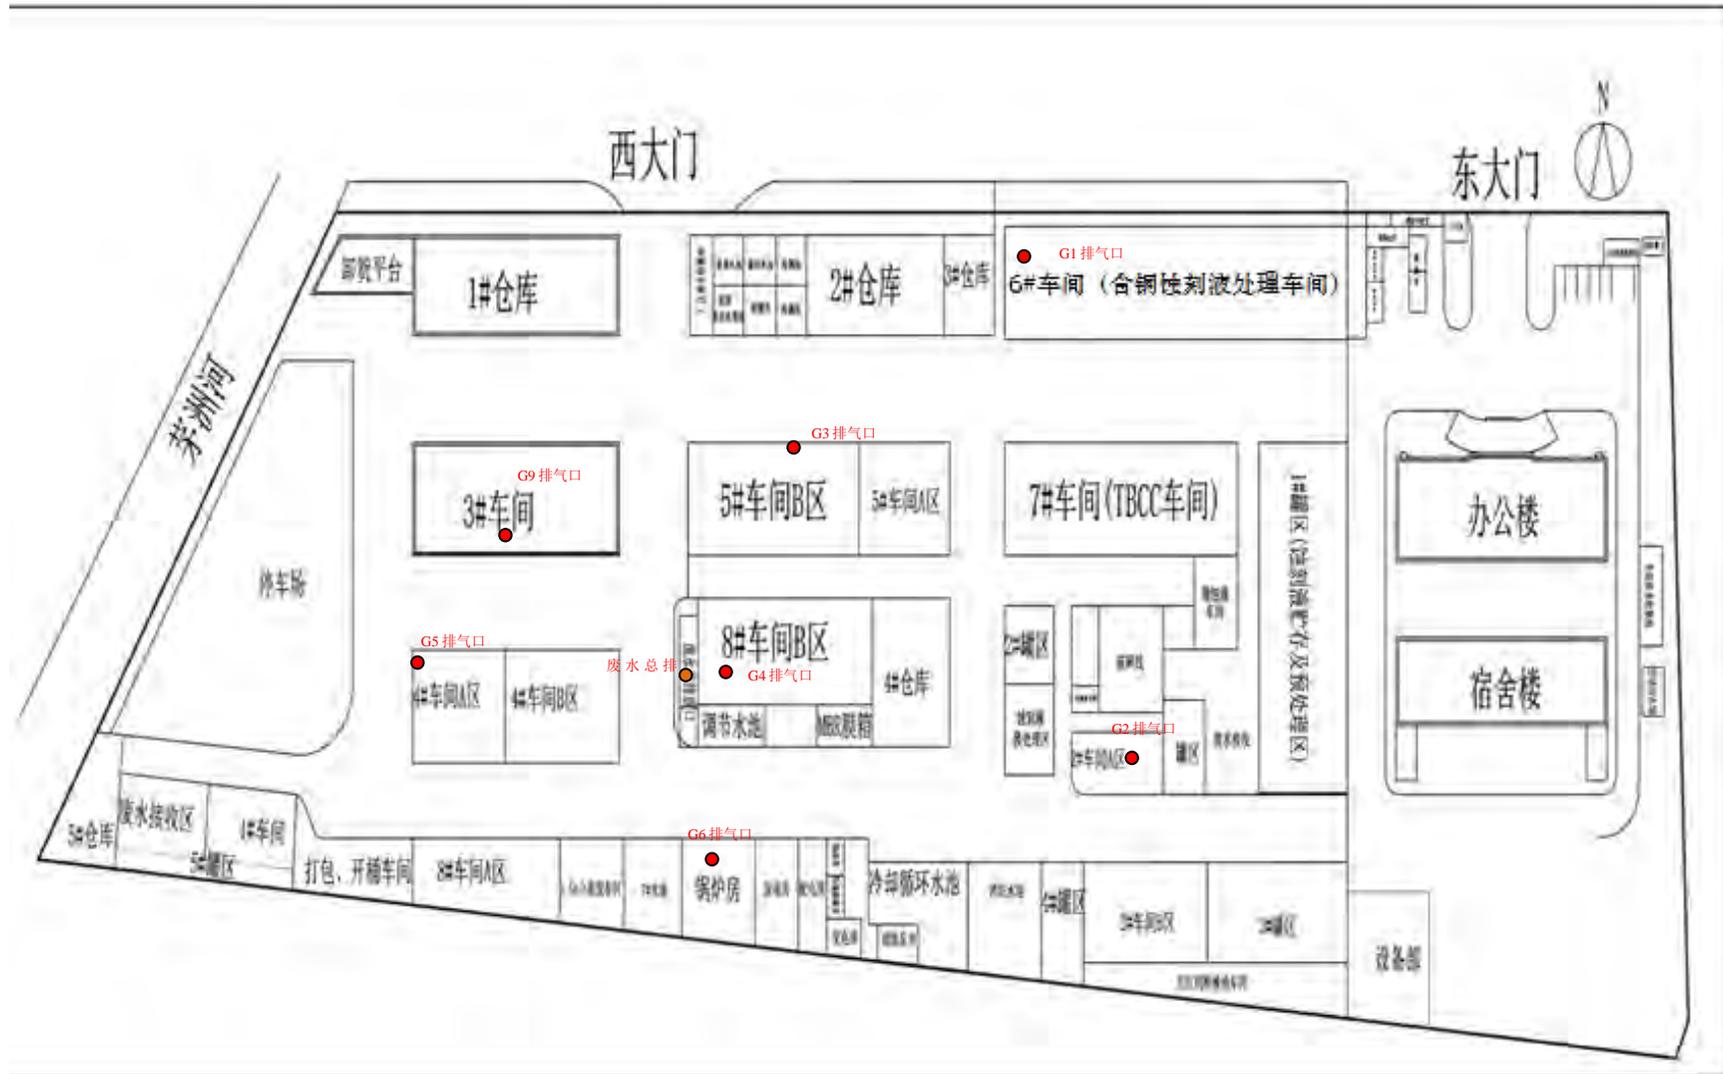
现有（改扩建一期）厂区总平面布置图
